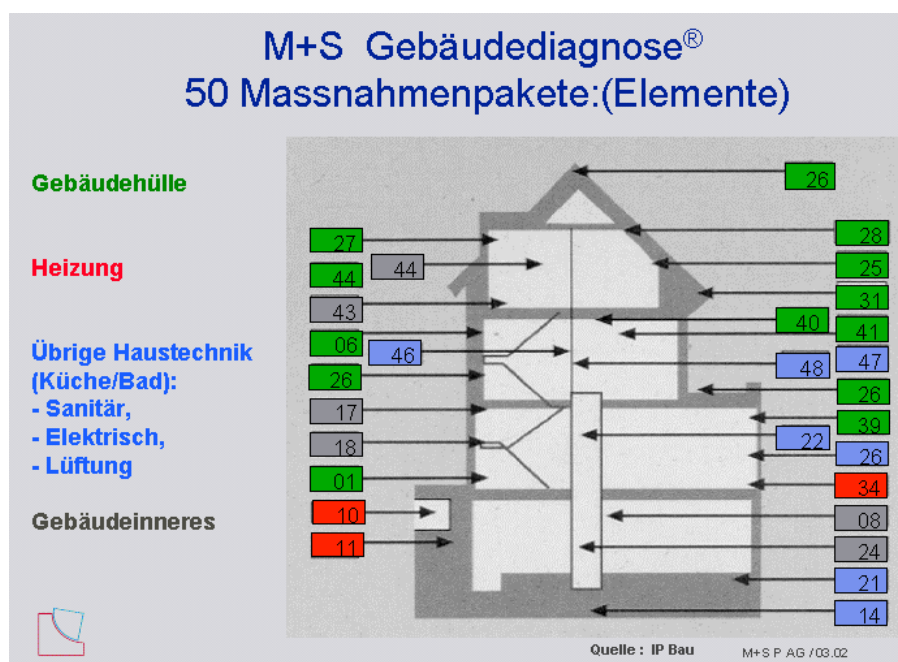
Elementierung eines Gebäudes nach der Methode IP Bau
